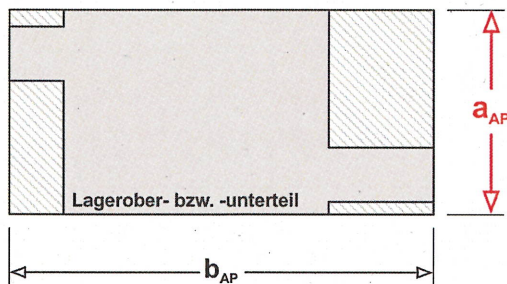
Grundrissabmessung des kleinsten Rechtecks, das die angrenzende Ankerplatte gerade noch umhüllt mit  $a_{AP} \leq b_{AP}$
